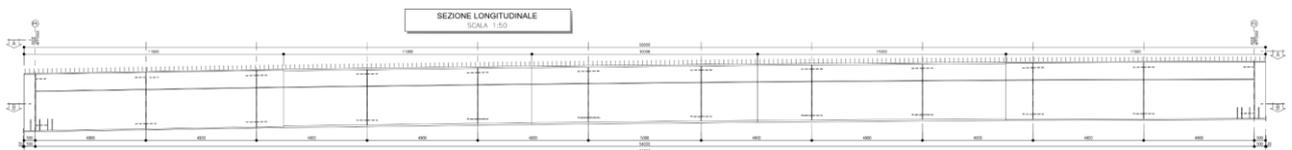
Prospetto della trave metallica dell'impalcato a sezione mista
